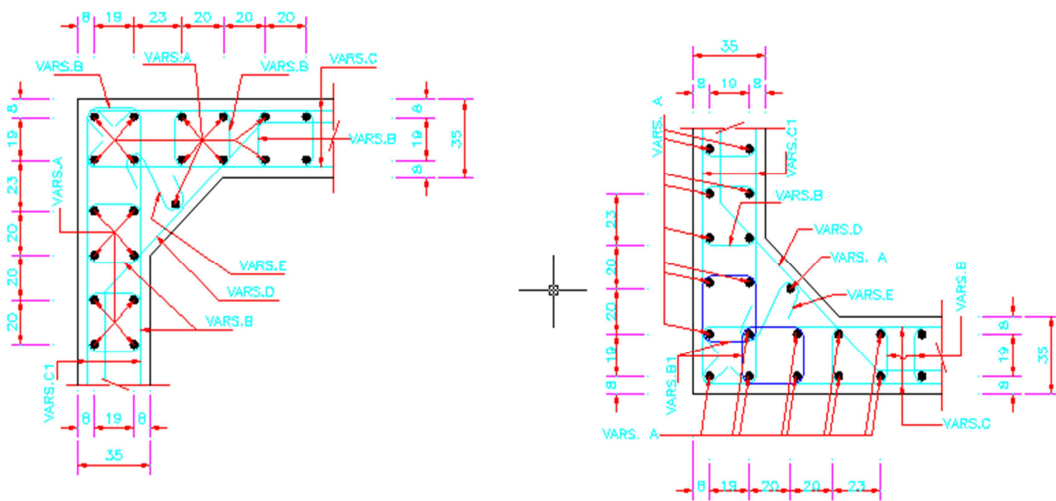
Armado del acero de refuerzo transversal en confinamiento
